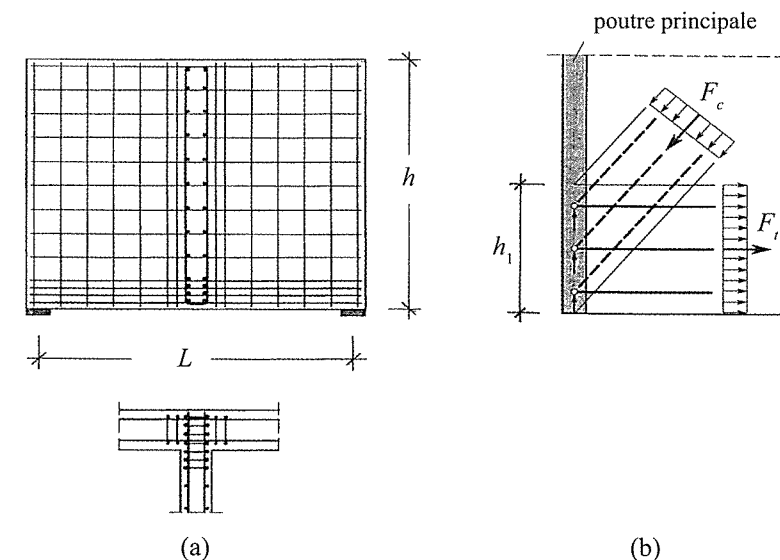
Chargement indirect inférieur d'une poutre-voile croisée sur une poutre-voile principale [3] : a) armatures de suspente de la réaction d'appui ; b) transmission par cisaillement sur une hauteur h_1 .
